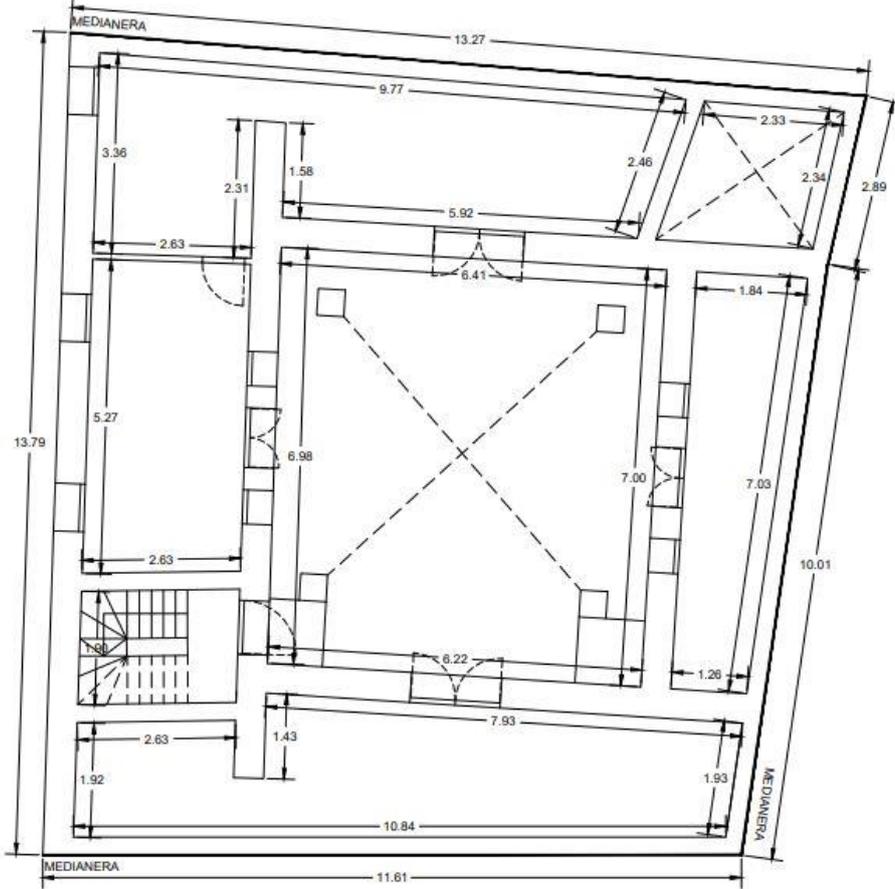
Plano planta primera del edificio (Elaboración propia)
